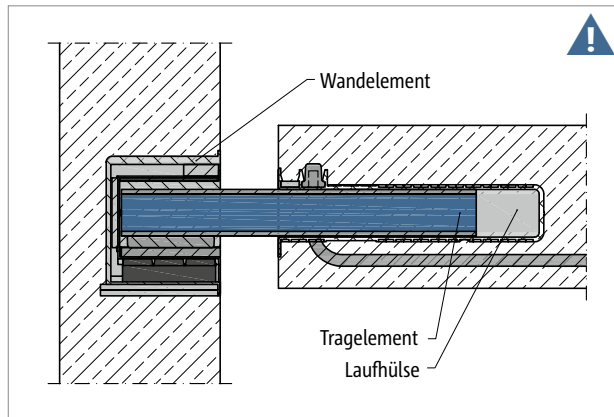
Schöck Tronsole® Typ Q: Mehrteiliges Produkt (Wandelement, Tragelement, Laufhülse); Tragelement (eingefärbt) muss auf der Baustelle eingebaut werden.
